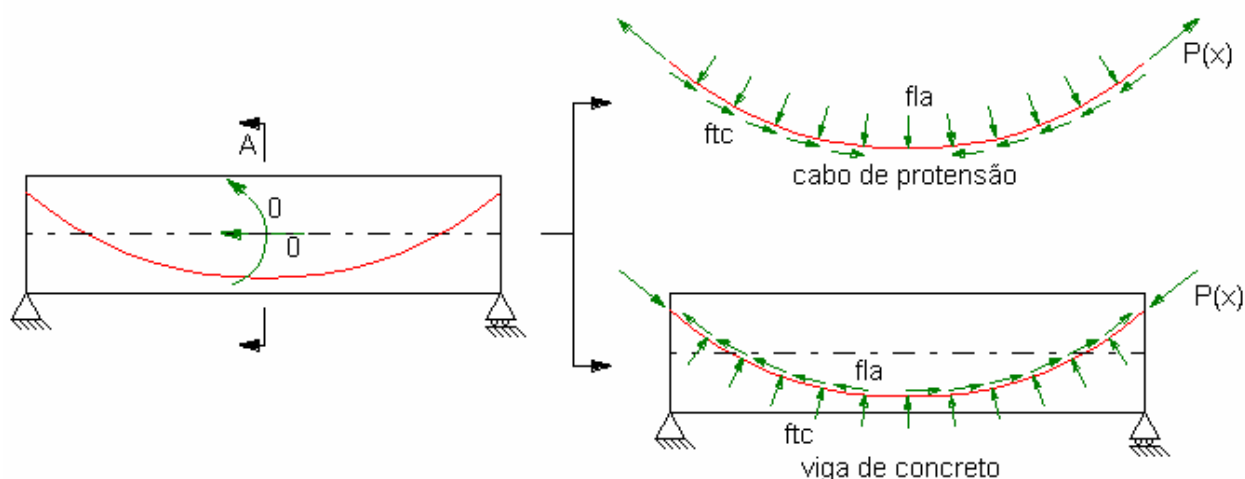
Viga de concreto e cabo de protensão, separados.
